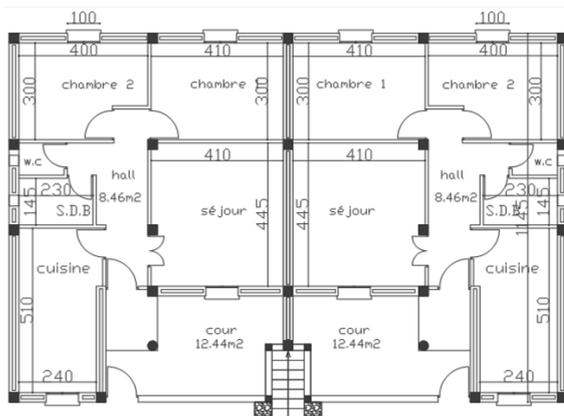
Structure type poteaux poutres voiles en béton armé. (Source : auteur)
